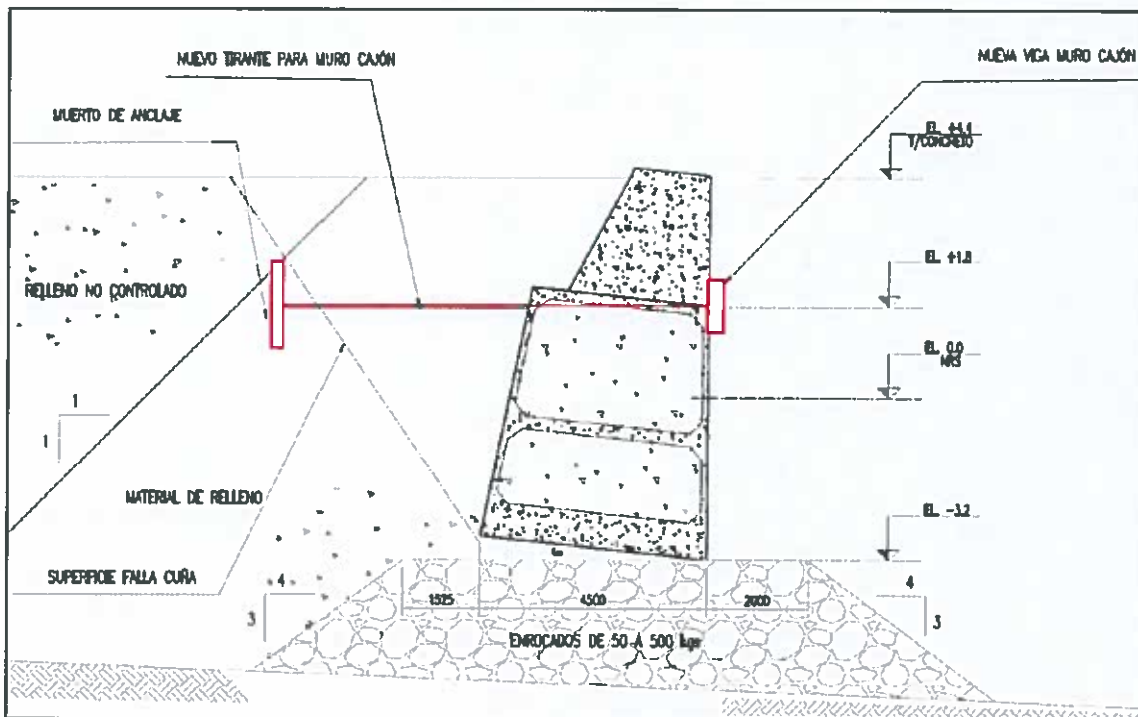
Sección transversal de Rehabilitación de muros Sitio N° 1
